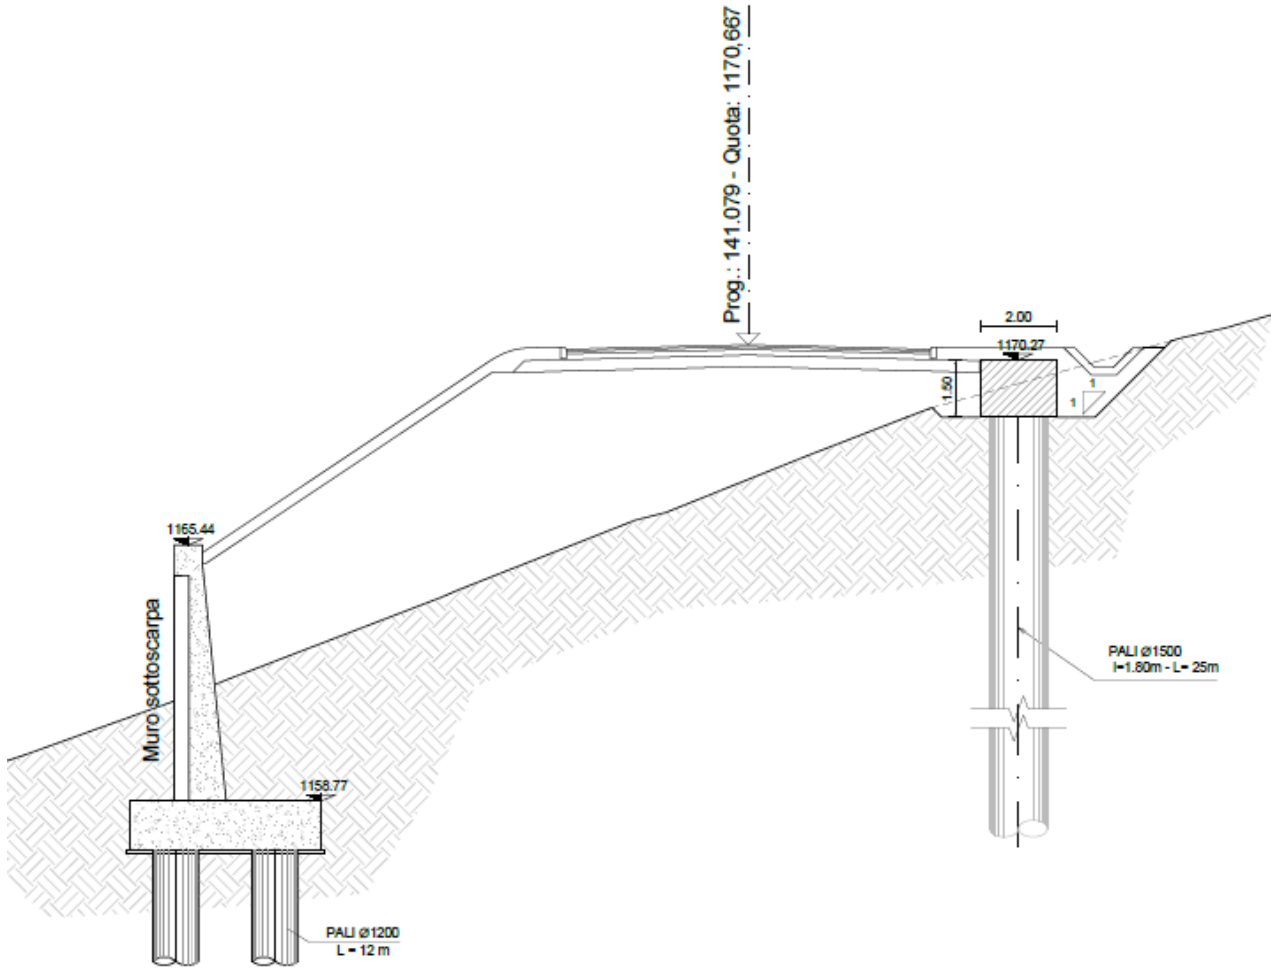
Sezione tipo intervento di stabilizzazione tramite pali
